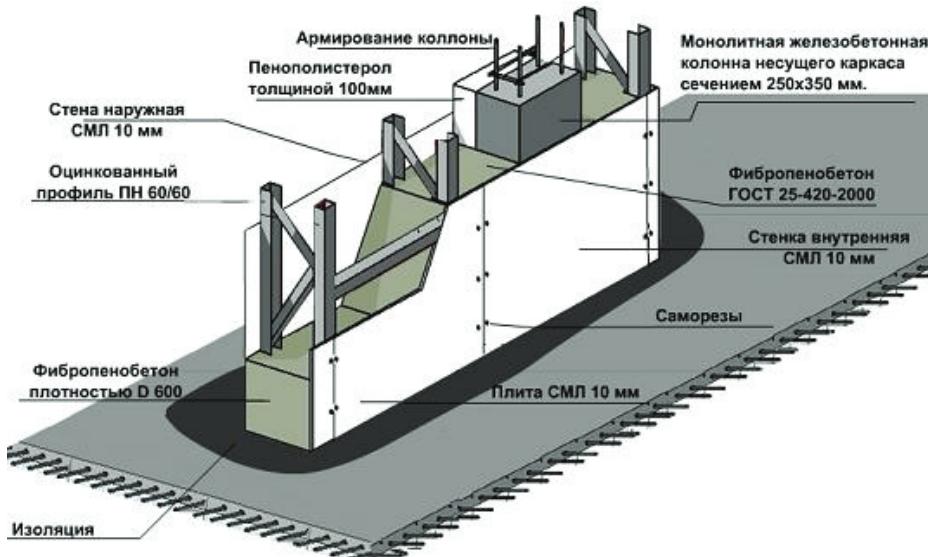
Разрез стены каркасно-монолитного строения. Наружная и внутренняя стена. Плита СМЛ как несъемная опалубка
